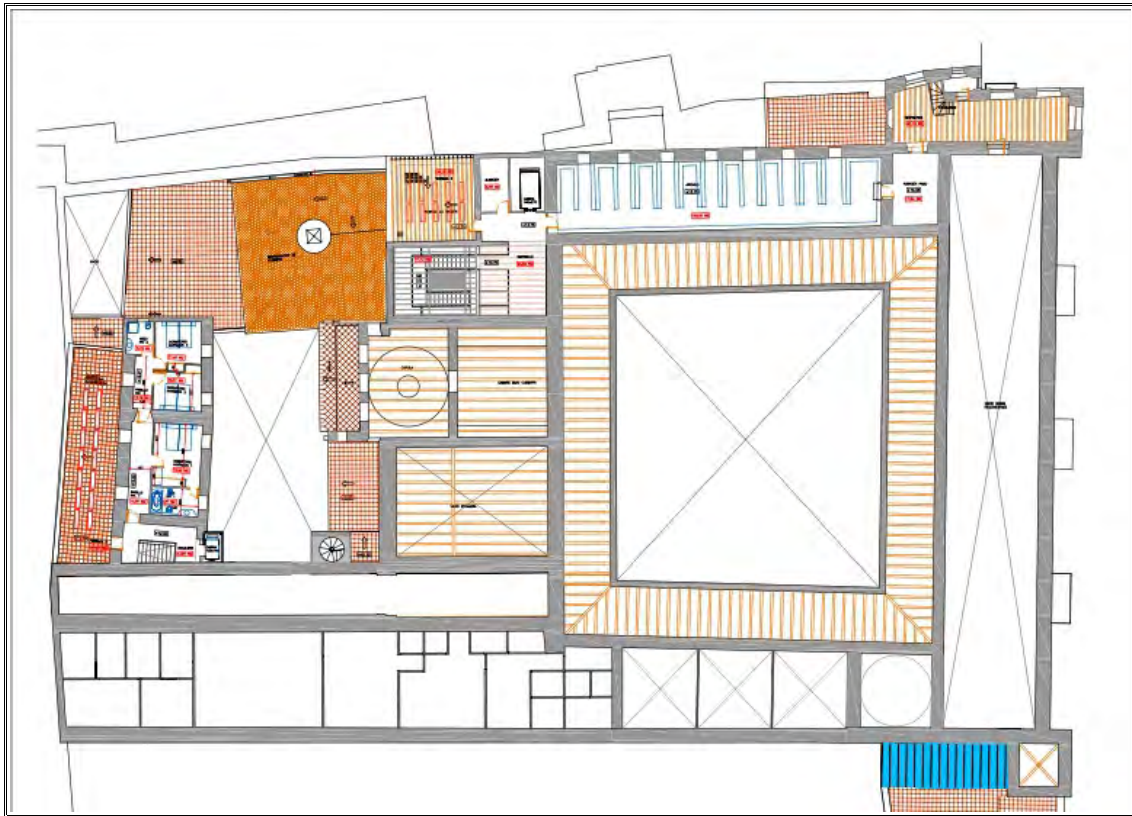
Estado reformado. Planta segunda. (OAFJ, R05).
